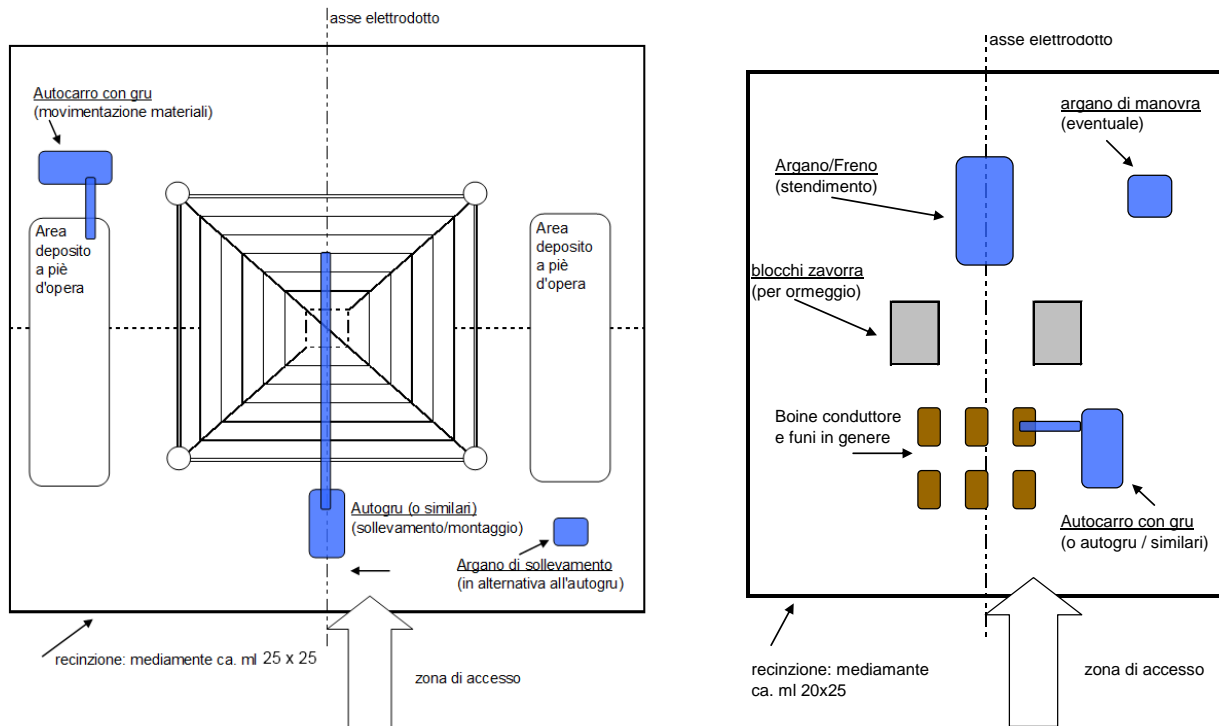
Planimetria dell'Area Sostegno (montaggio sostegno) - Planimetria dell'Area di linea - Tipologico
